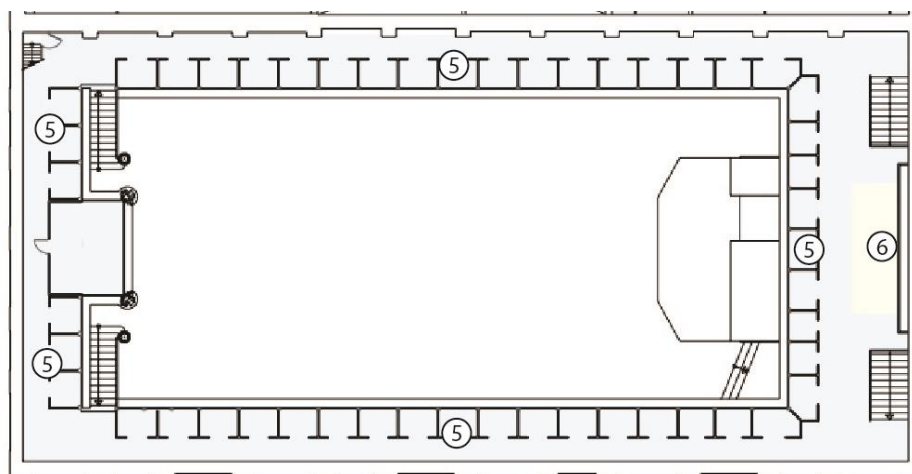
Distribución de Planta baja (Sala de usos Múltiples)
